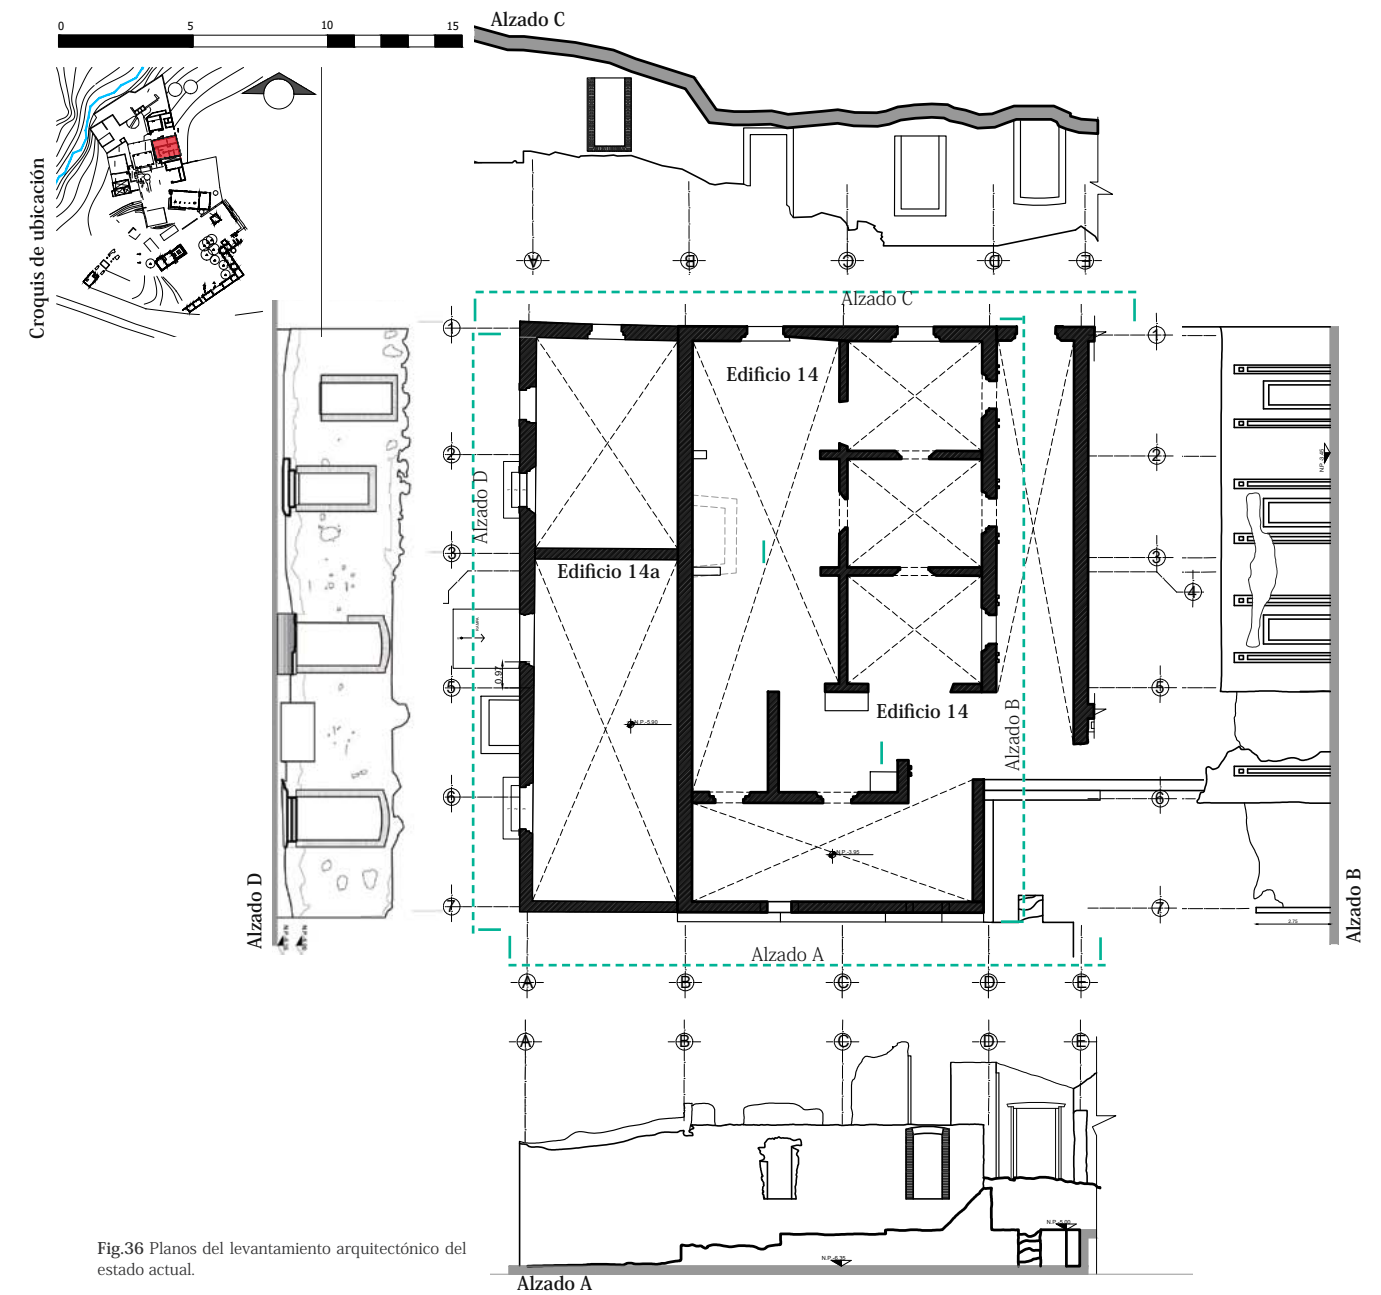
Planos del levantamiento arquitectónico del estado actual.
